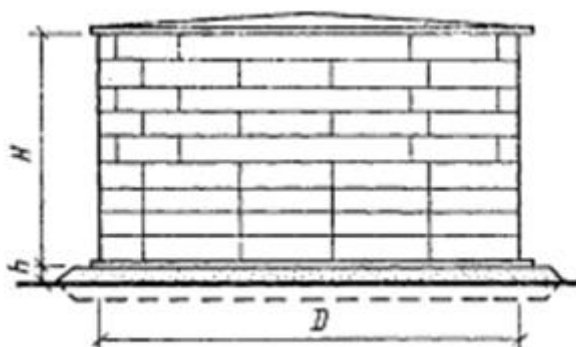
Загальний вигляд вертикального циліндричного резервуара
